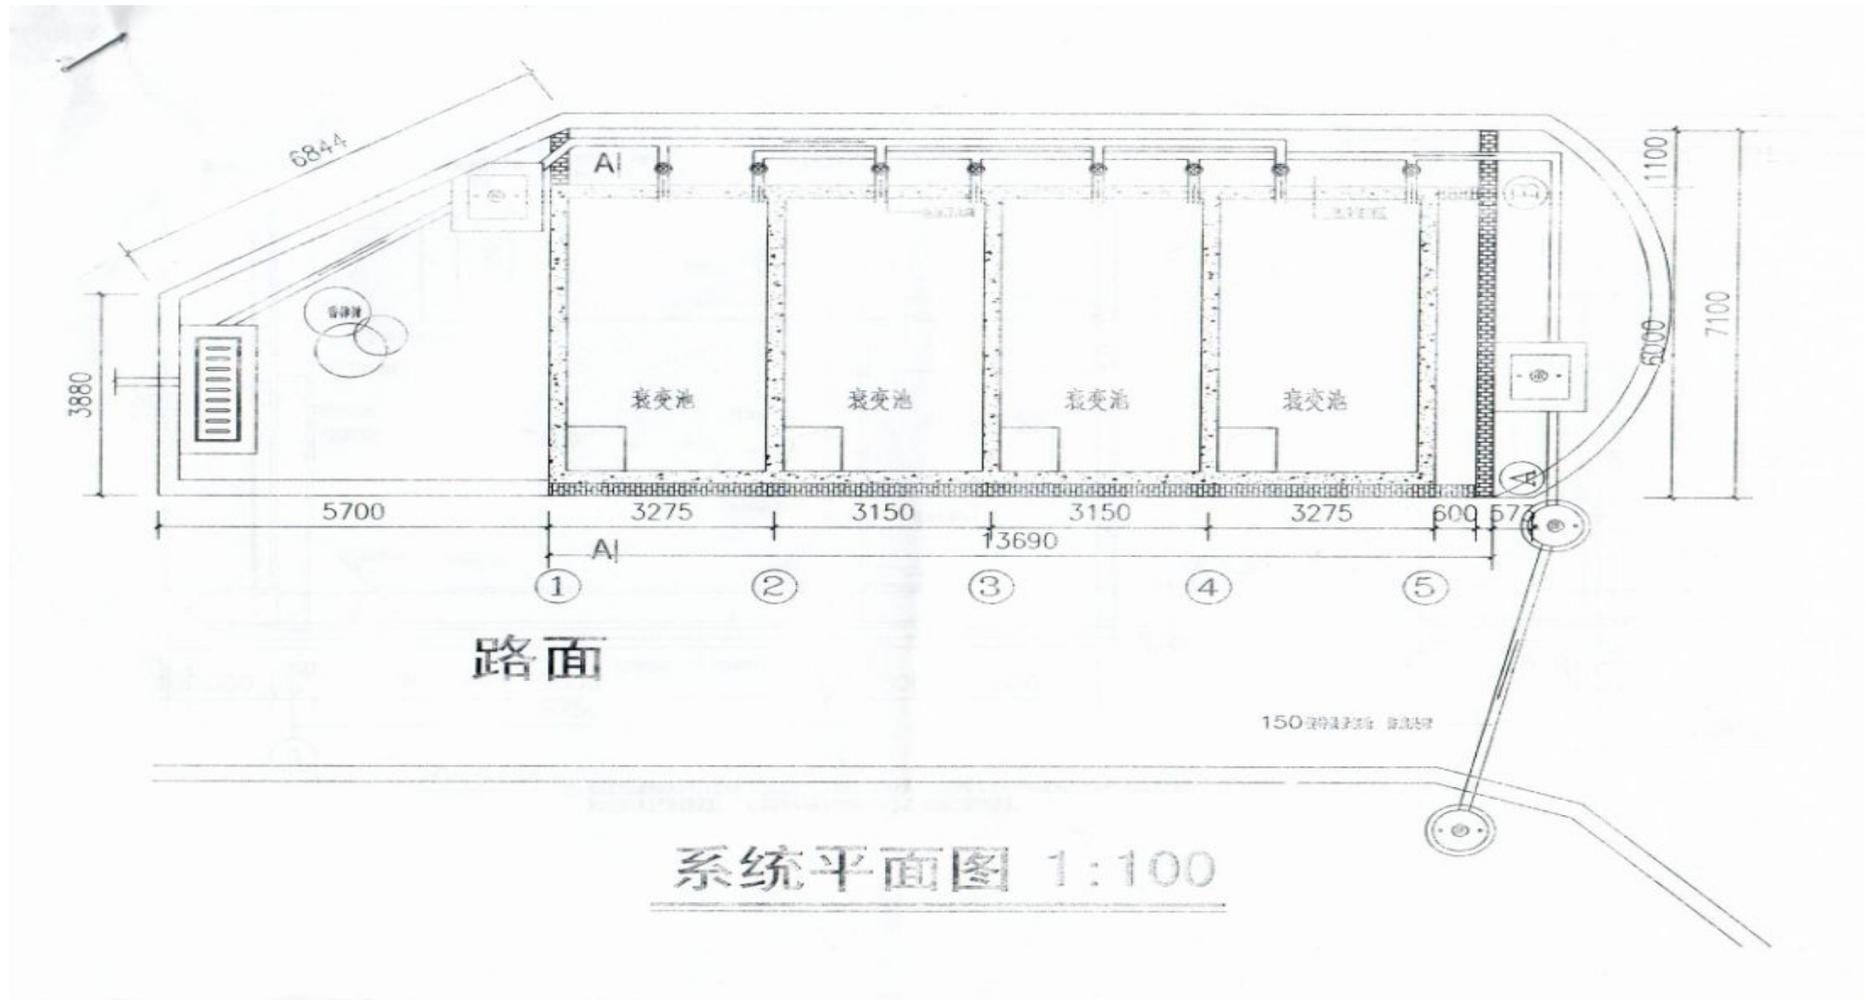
(1) 浙江省肿瘤医院新建衰变池总平面布置图
